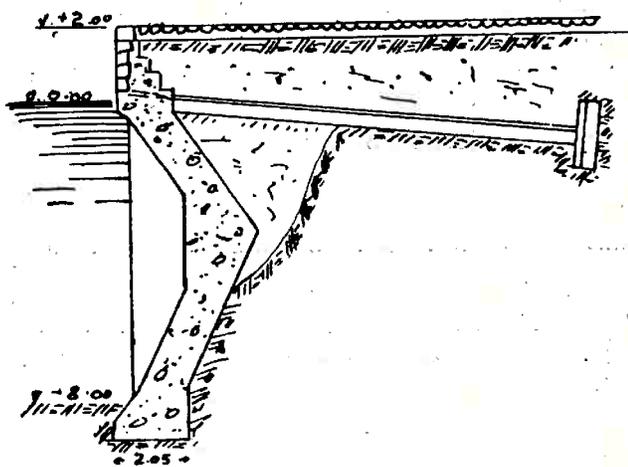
Muro ancorado da bacia Tegholm — Copenhagen.
